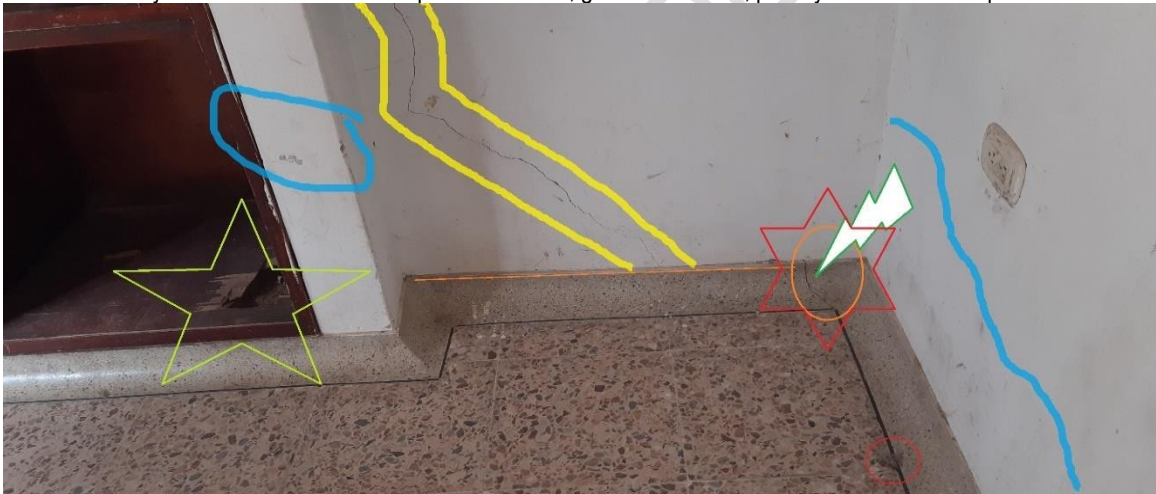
Fisura, agrietamiento y desprendimiento de zócalos, debido descalcificación del pegamento, humedad.
